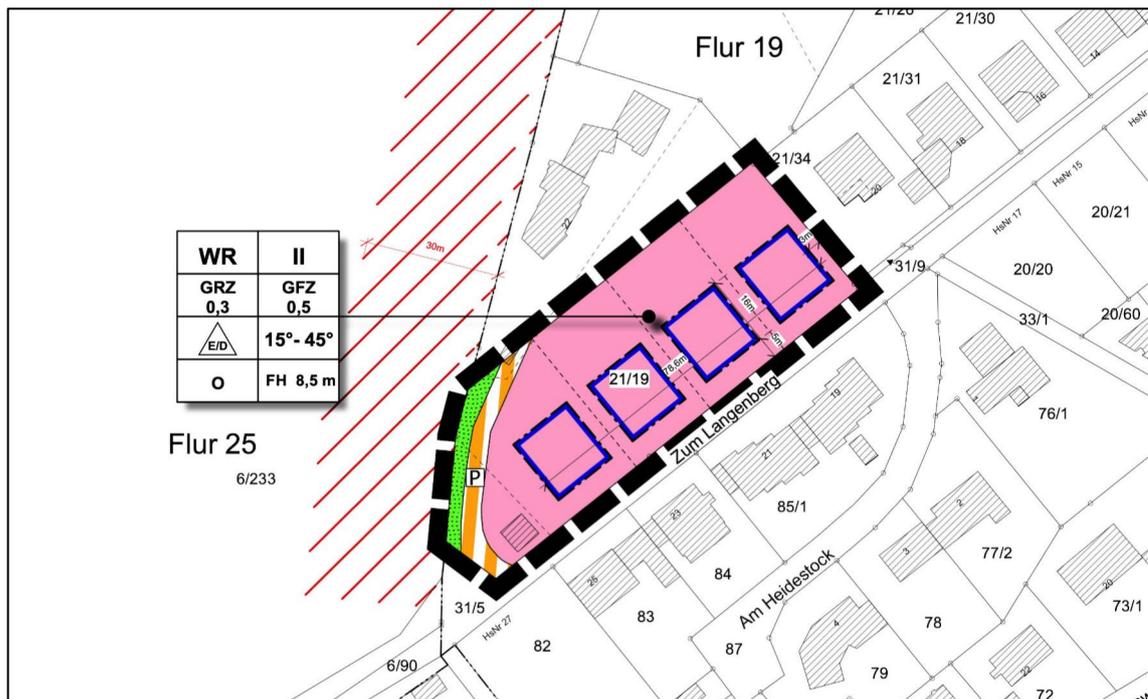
B-Plan „Zum Langenberg 22, 1. Änderung“ - Planteil
